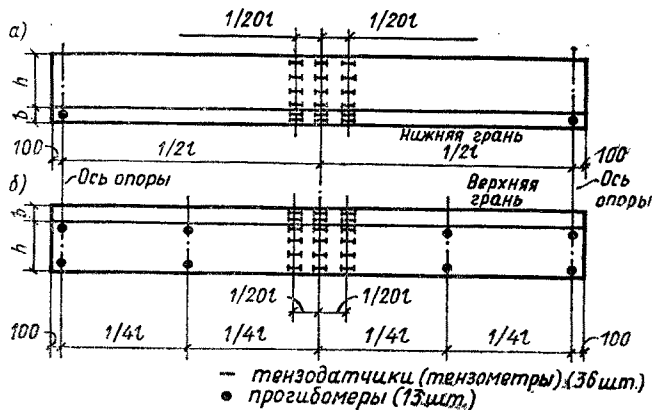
Примерная схема расположения прогибомеров и тензометров при испытании опытных стеновых панелей
